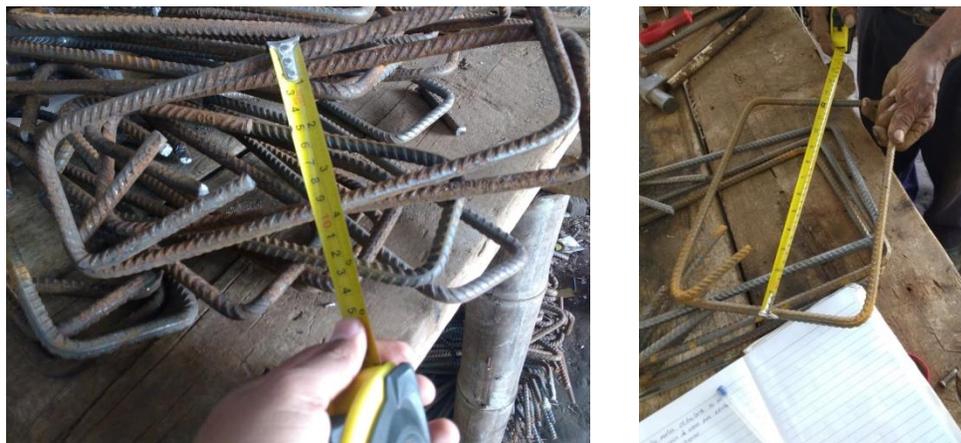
Figuración de estribos para vigas de losa de entrepiso. Fuente: tomada por pasante.
